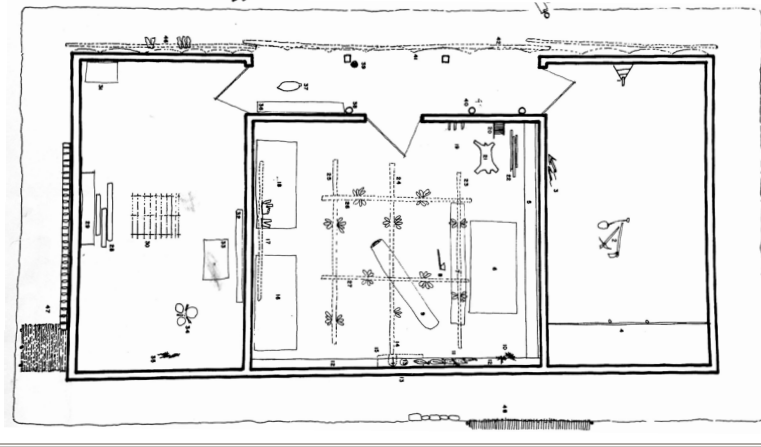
Planta Única de vivienda tradicional del pueblo Saraguro
